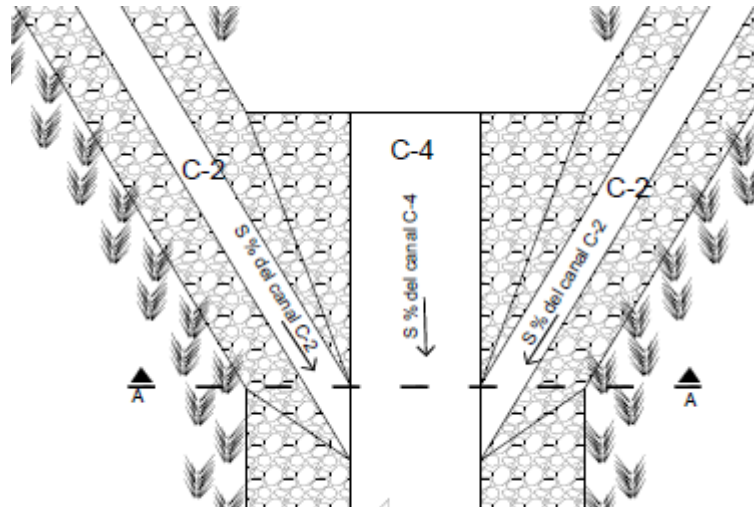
Detalle típico Empalme canales C-2 a C-4 (sin escala)
